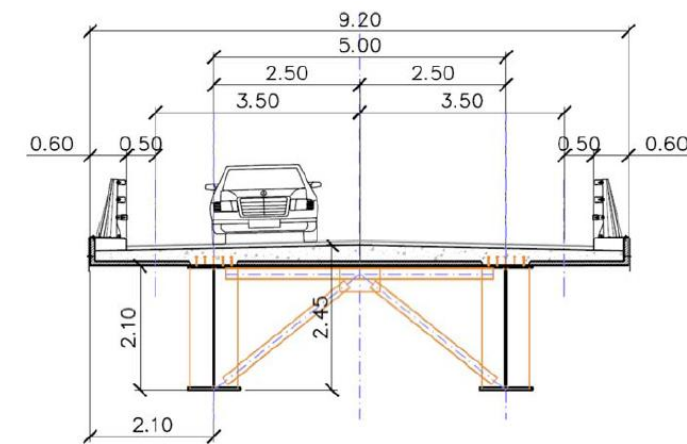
Sección tipo mixto (bijácena y losa de hormigón)
